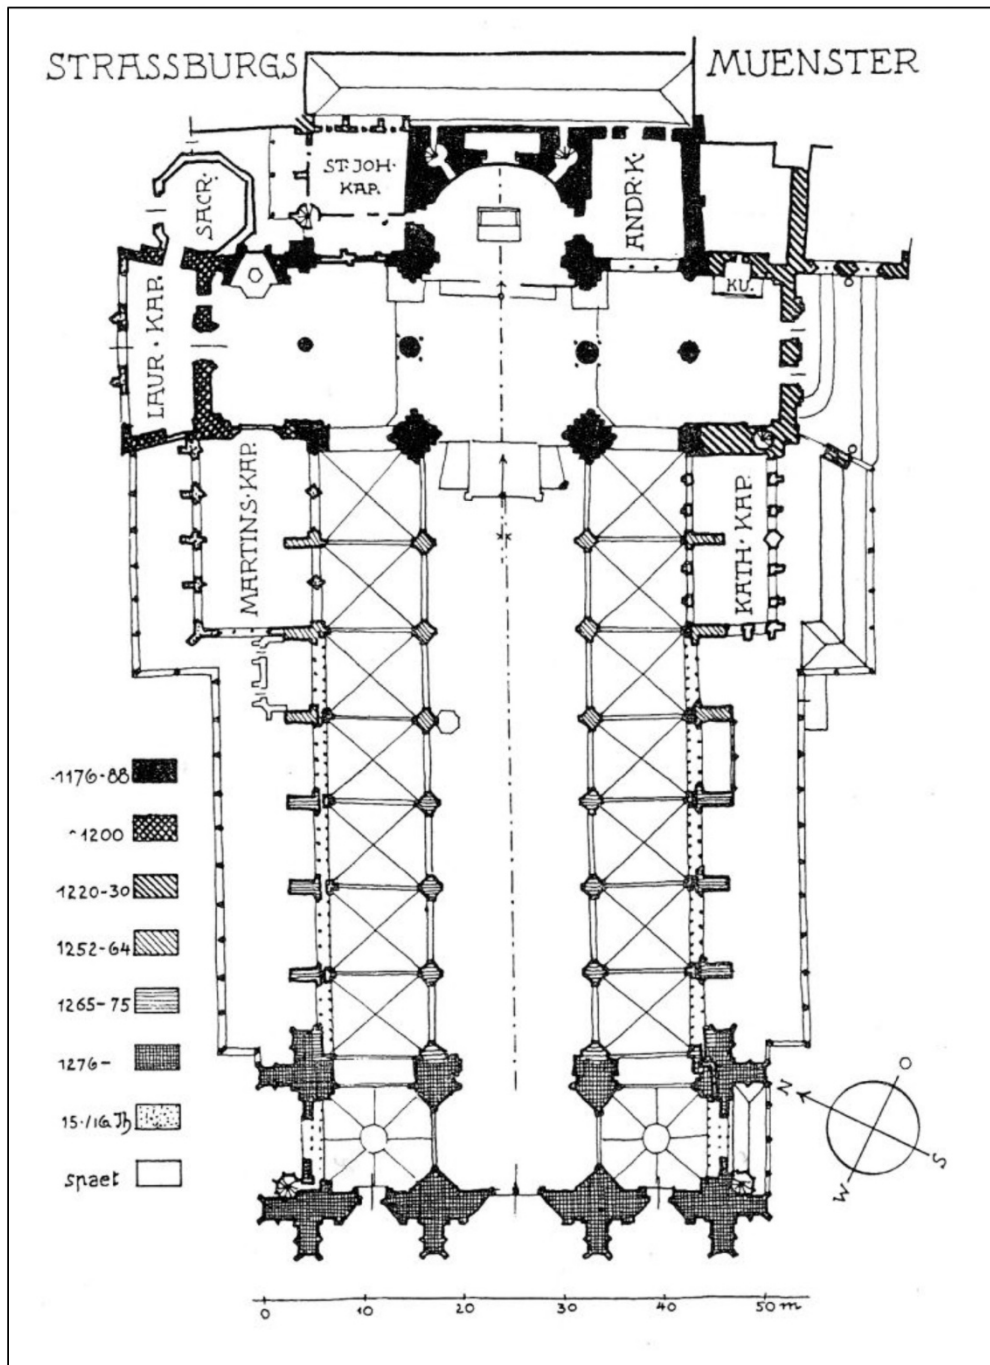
Grundriss des Straßburger Münsters mit Bauphasen
